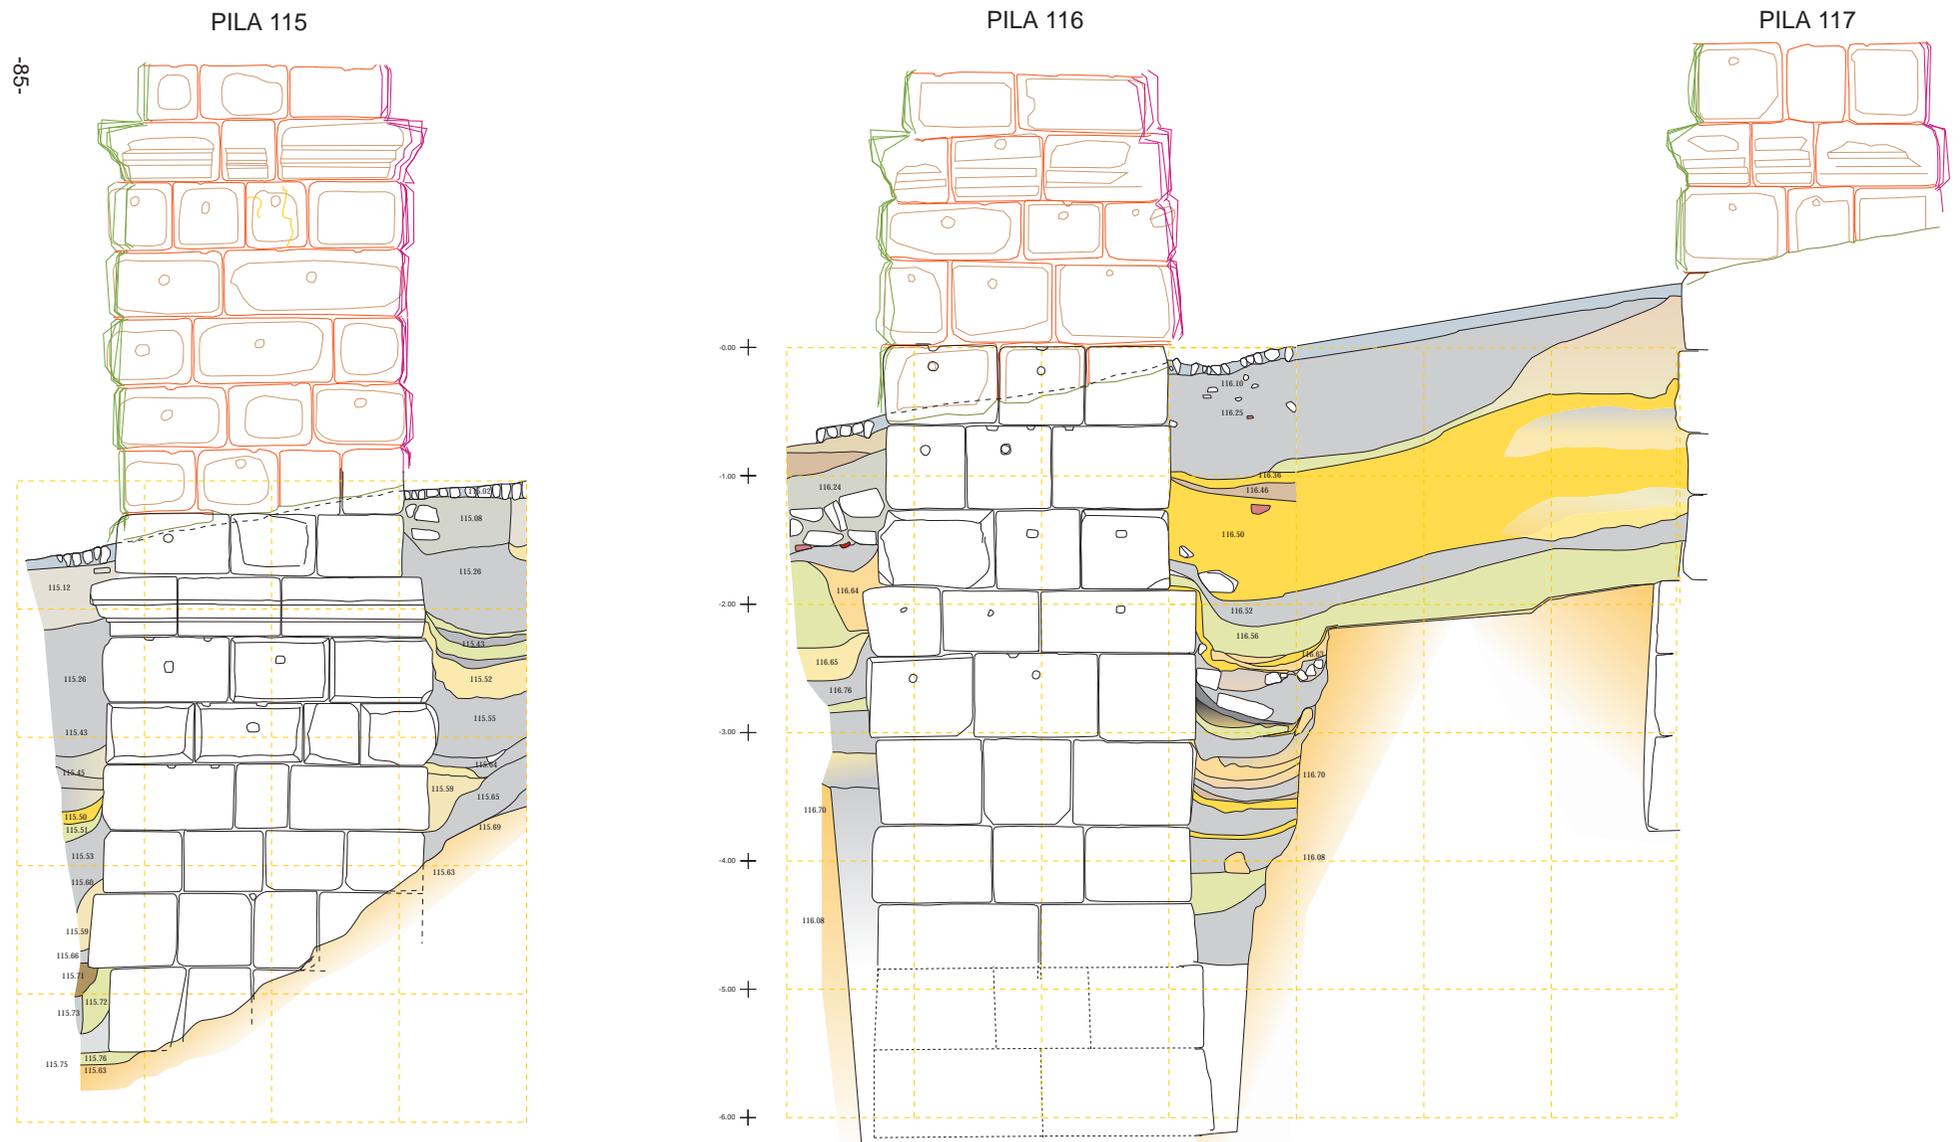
Alzados conjuntos de las pilas 115, 116 y 117.
